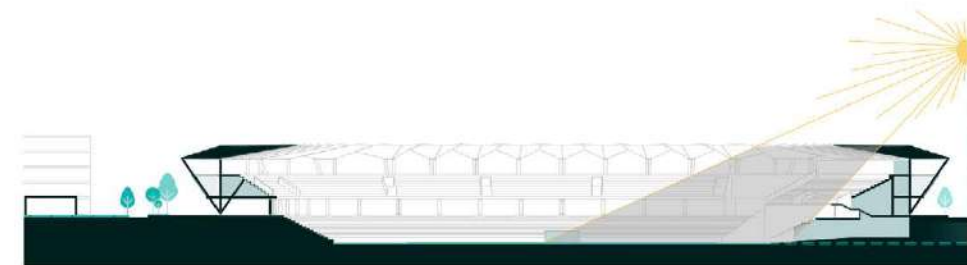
Cubierta no permeable Fuente: Elaboración propia
